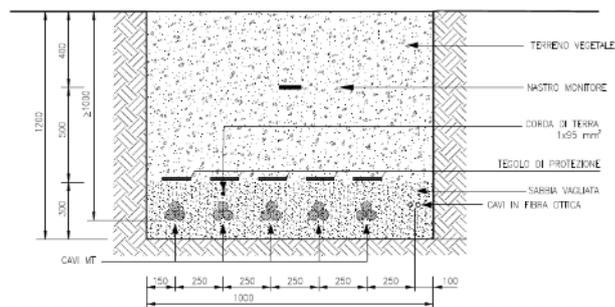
Sezioni di posa cavidotti in terreno vegetale
